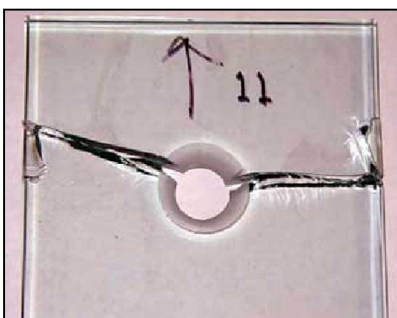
Rotura de placa de vidrio. Design Glass Holes for Bearing
